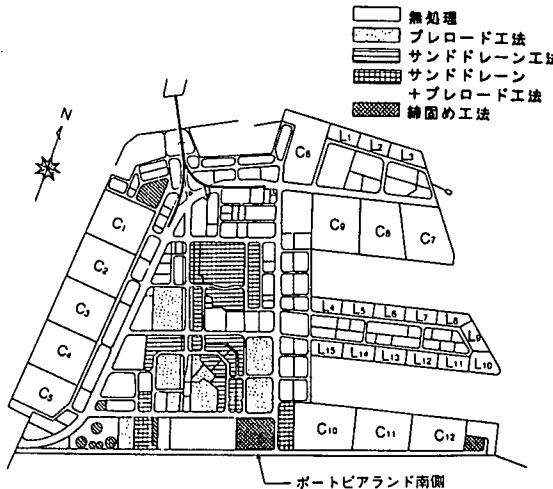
ポートアイランドの地盤改良域平面図¹⁾に加筆
